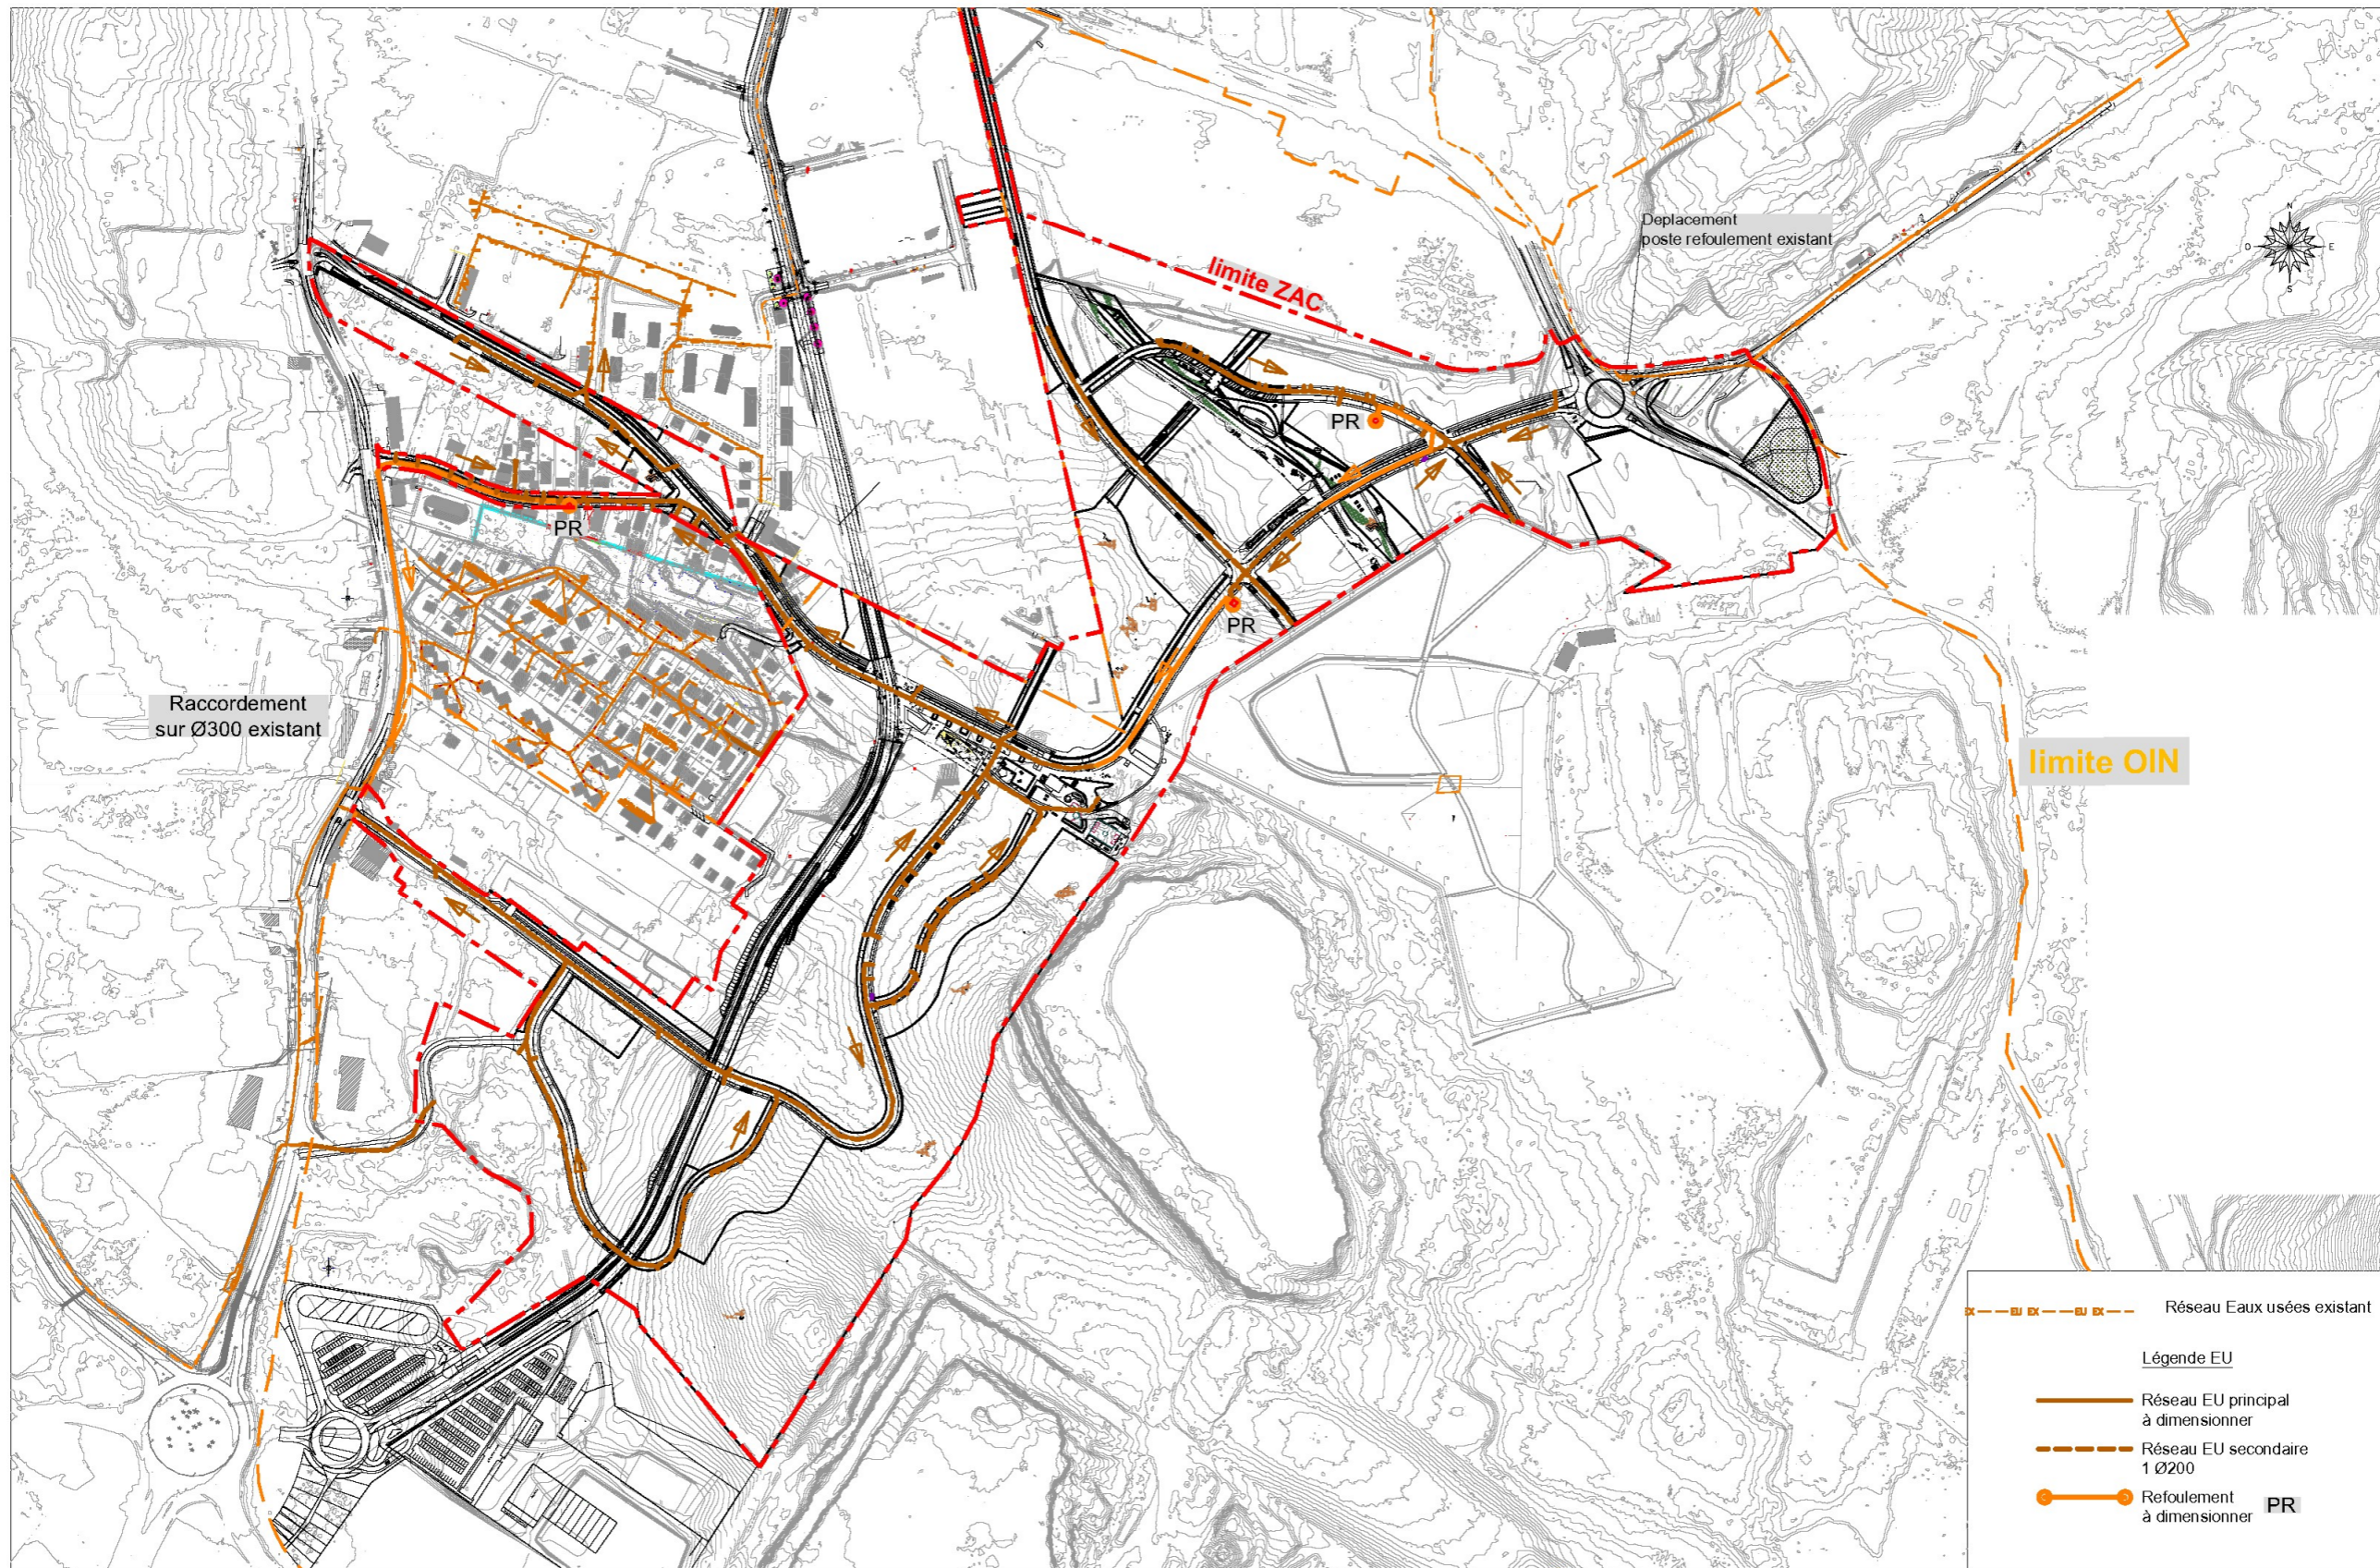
PLAN RESEAU EAUX USEES PROJETE POUR LA ZAC1 (A234, AVP 2020)
